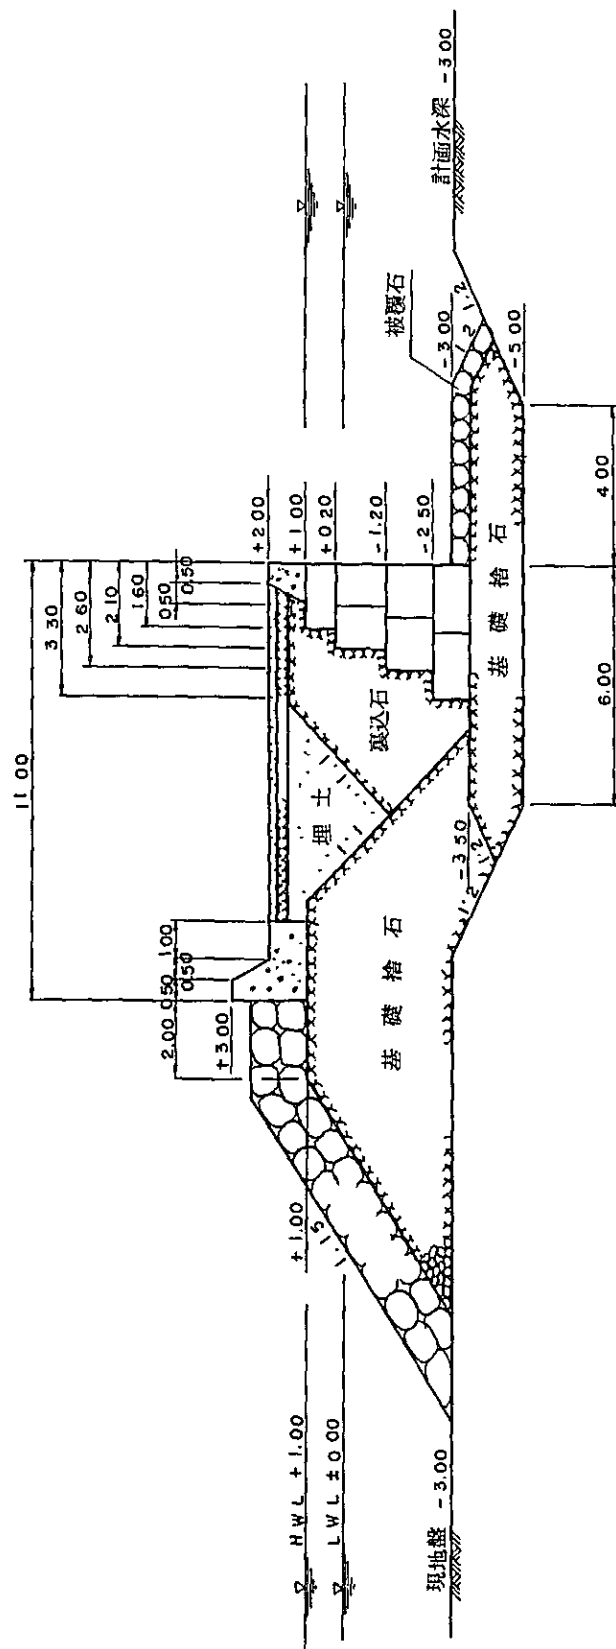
防波堤及び岸壁(-3.0m)の標準断面図
